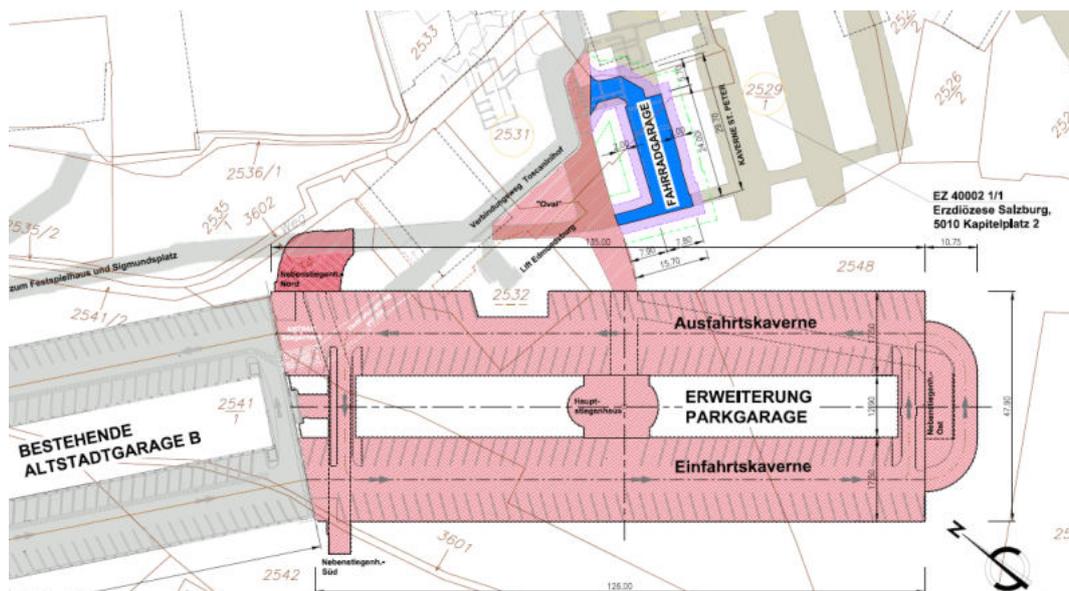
Mögliche Fahrradgarage (blau) in der Erweiterung der Mönchsberggarage (Quelle: Stadt Salzburg)
